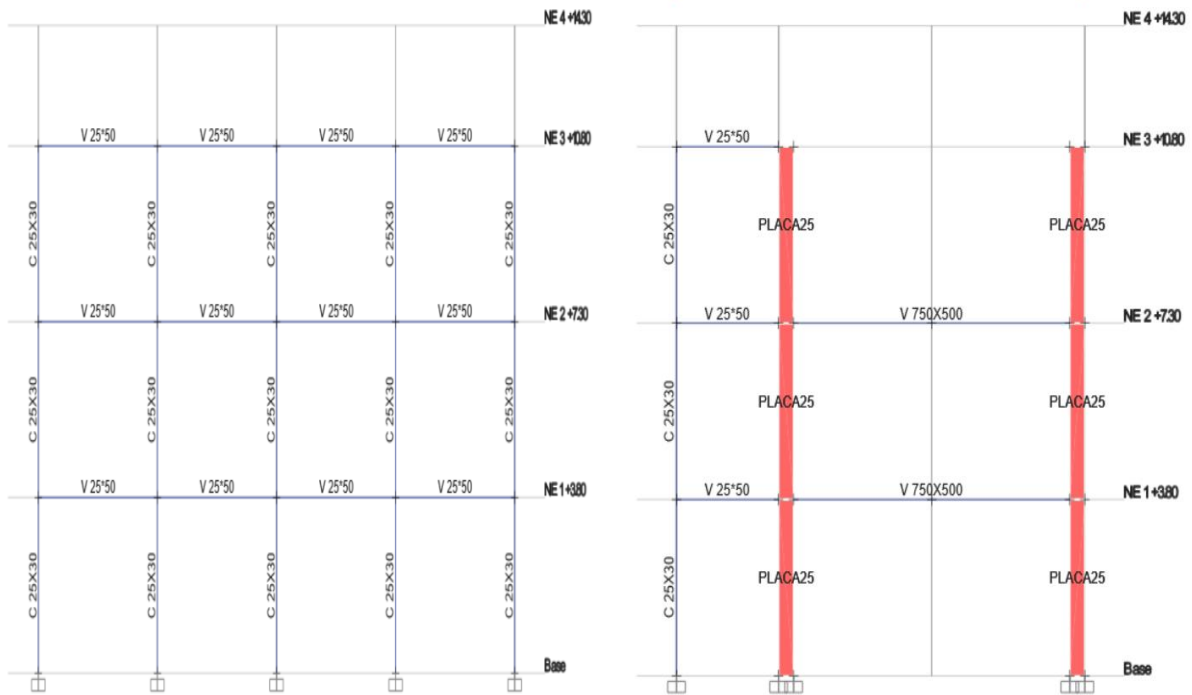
Se colocan los elementos estructurales columnas, vigas
